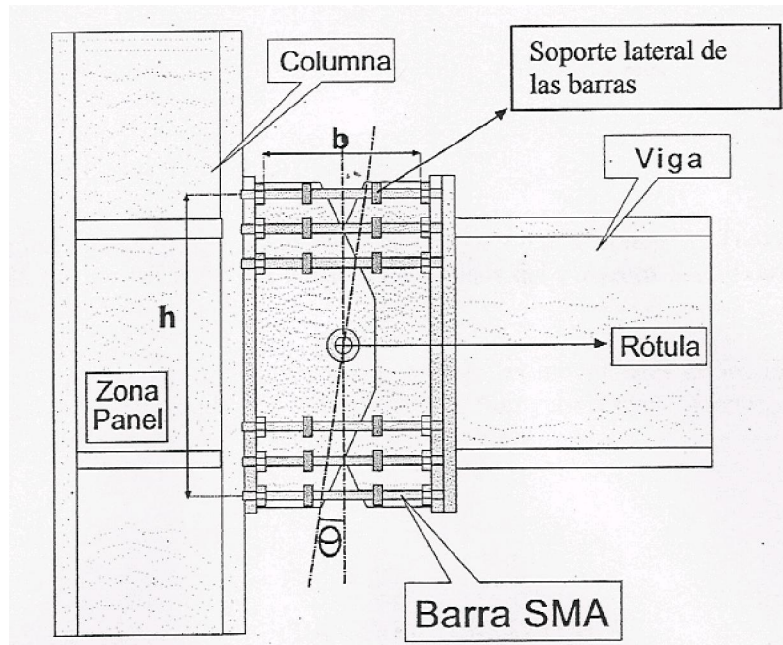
Esquema de conexión viga-columna con disipadores [2]
